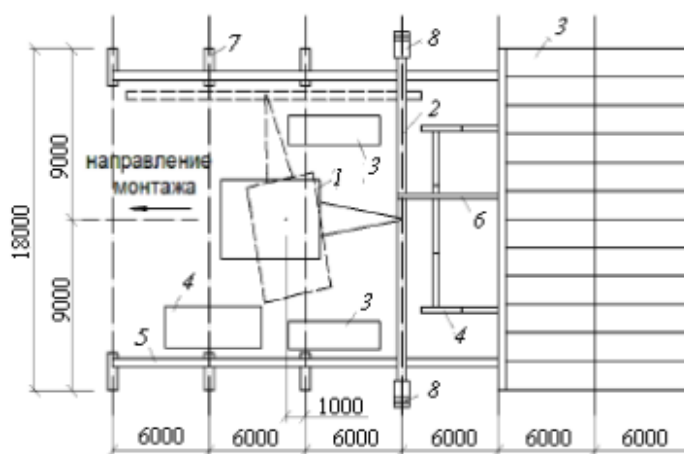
Схема монтажа здания фильтров водоочистной станции:
